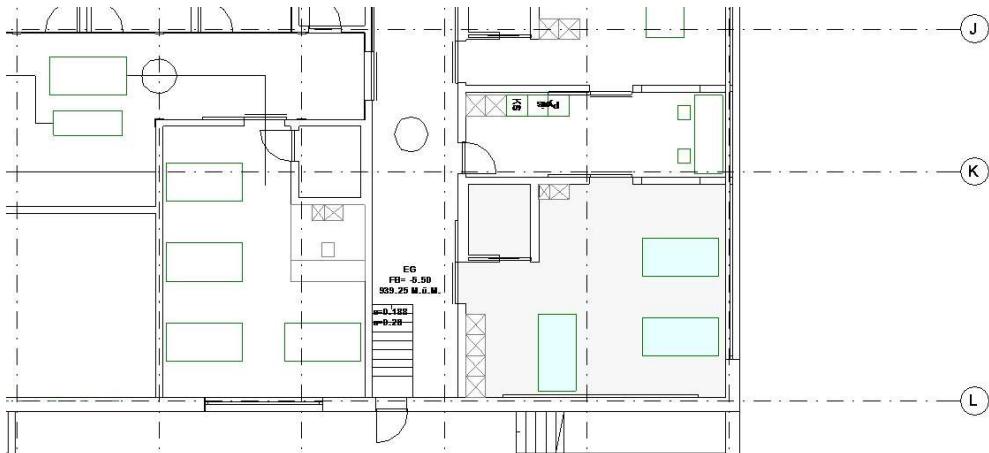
Ansicht Modell im Grundriss, Neubau Spital Zweisimmen
